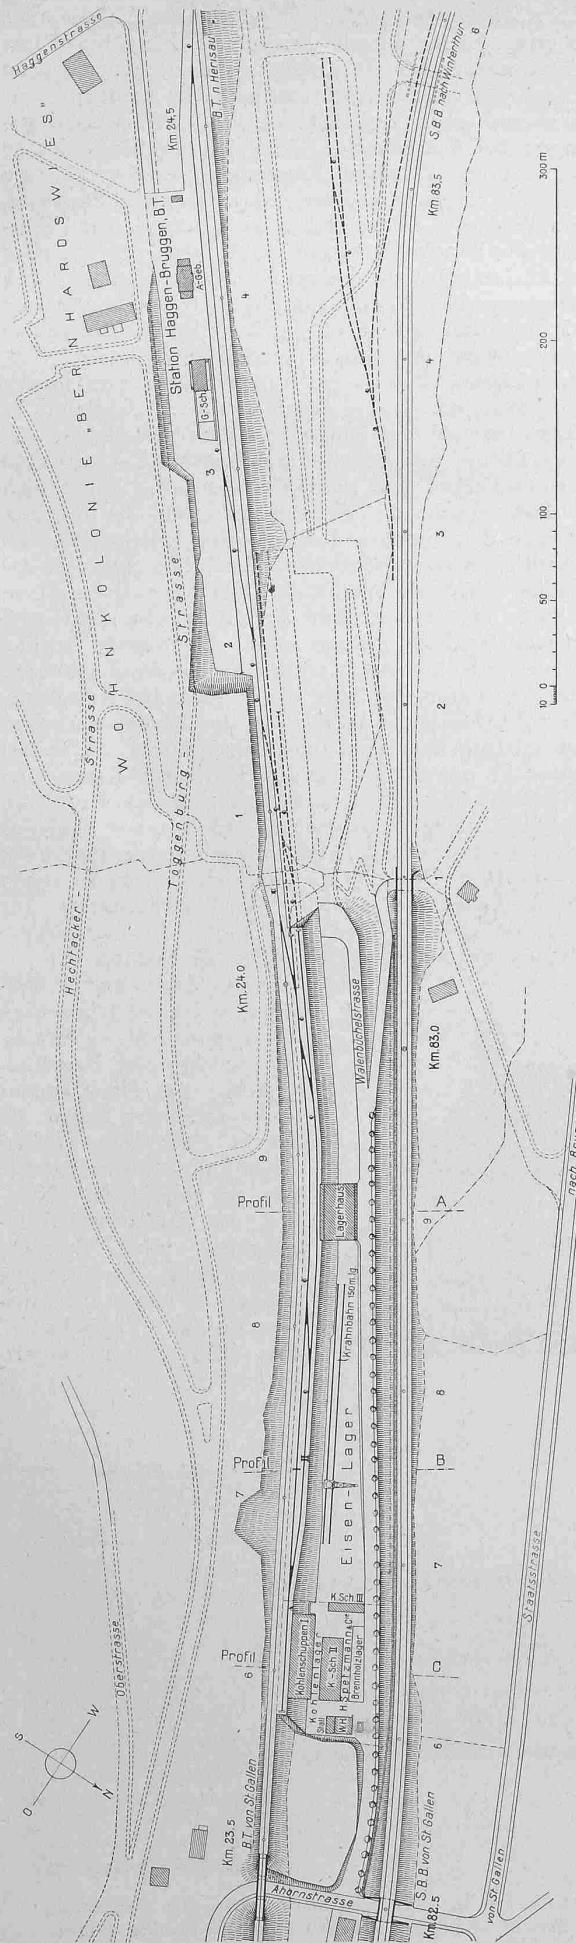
Lageplan der Vereinigten Lagerplätze Hagen-Bruggen bei St. Gallen. Entwurf und Bauleitung Ing. H. Sommer, St. Gallen. — Massstab 1:4000.
